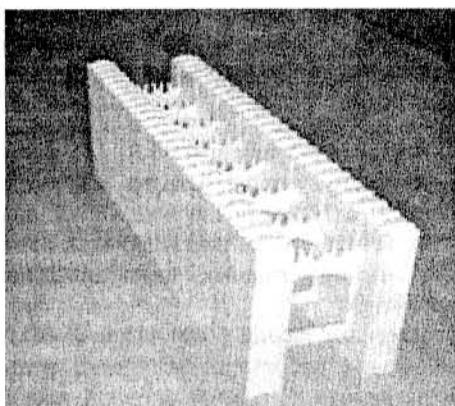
Блок стенной прямой и блок угловой пенополистирольной несъемной опалубки
